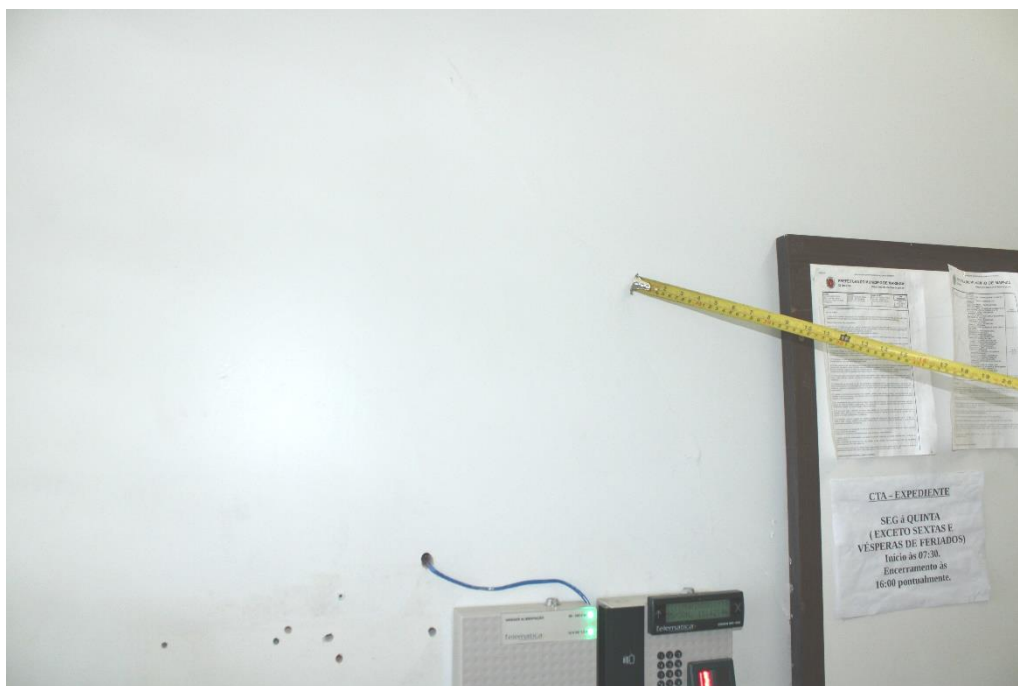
Vista parcial do corredor (parede confinante a sala 53), destacando sinais de correções de fissuras.
